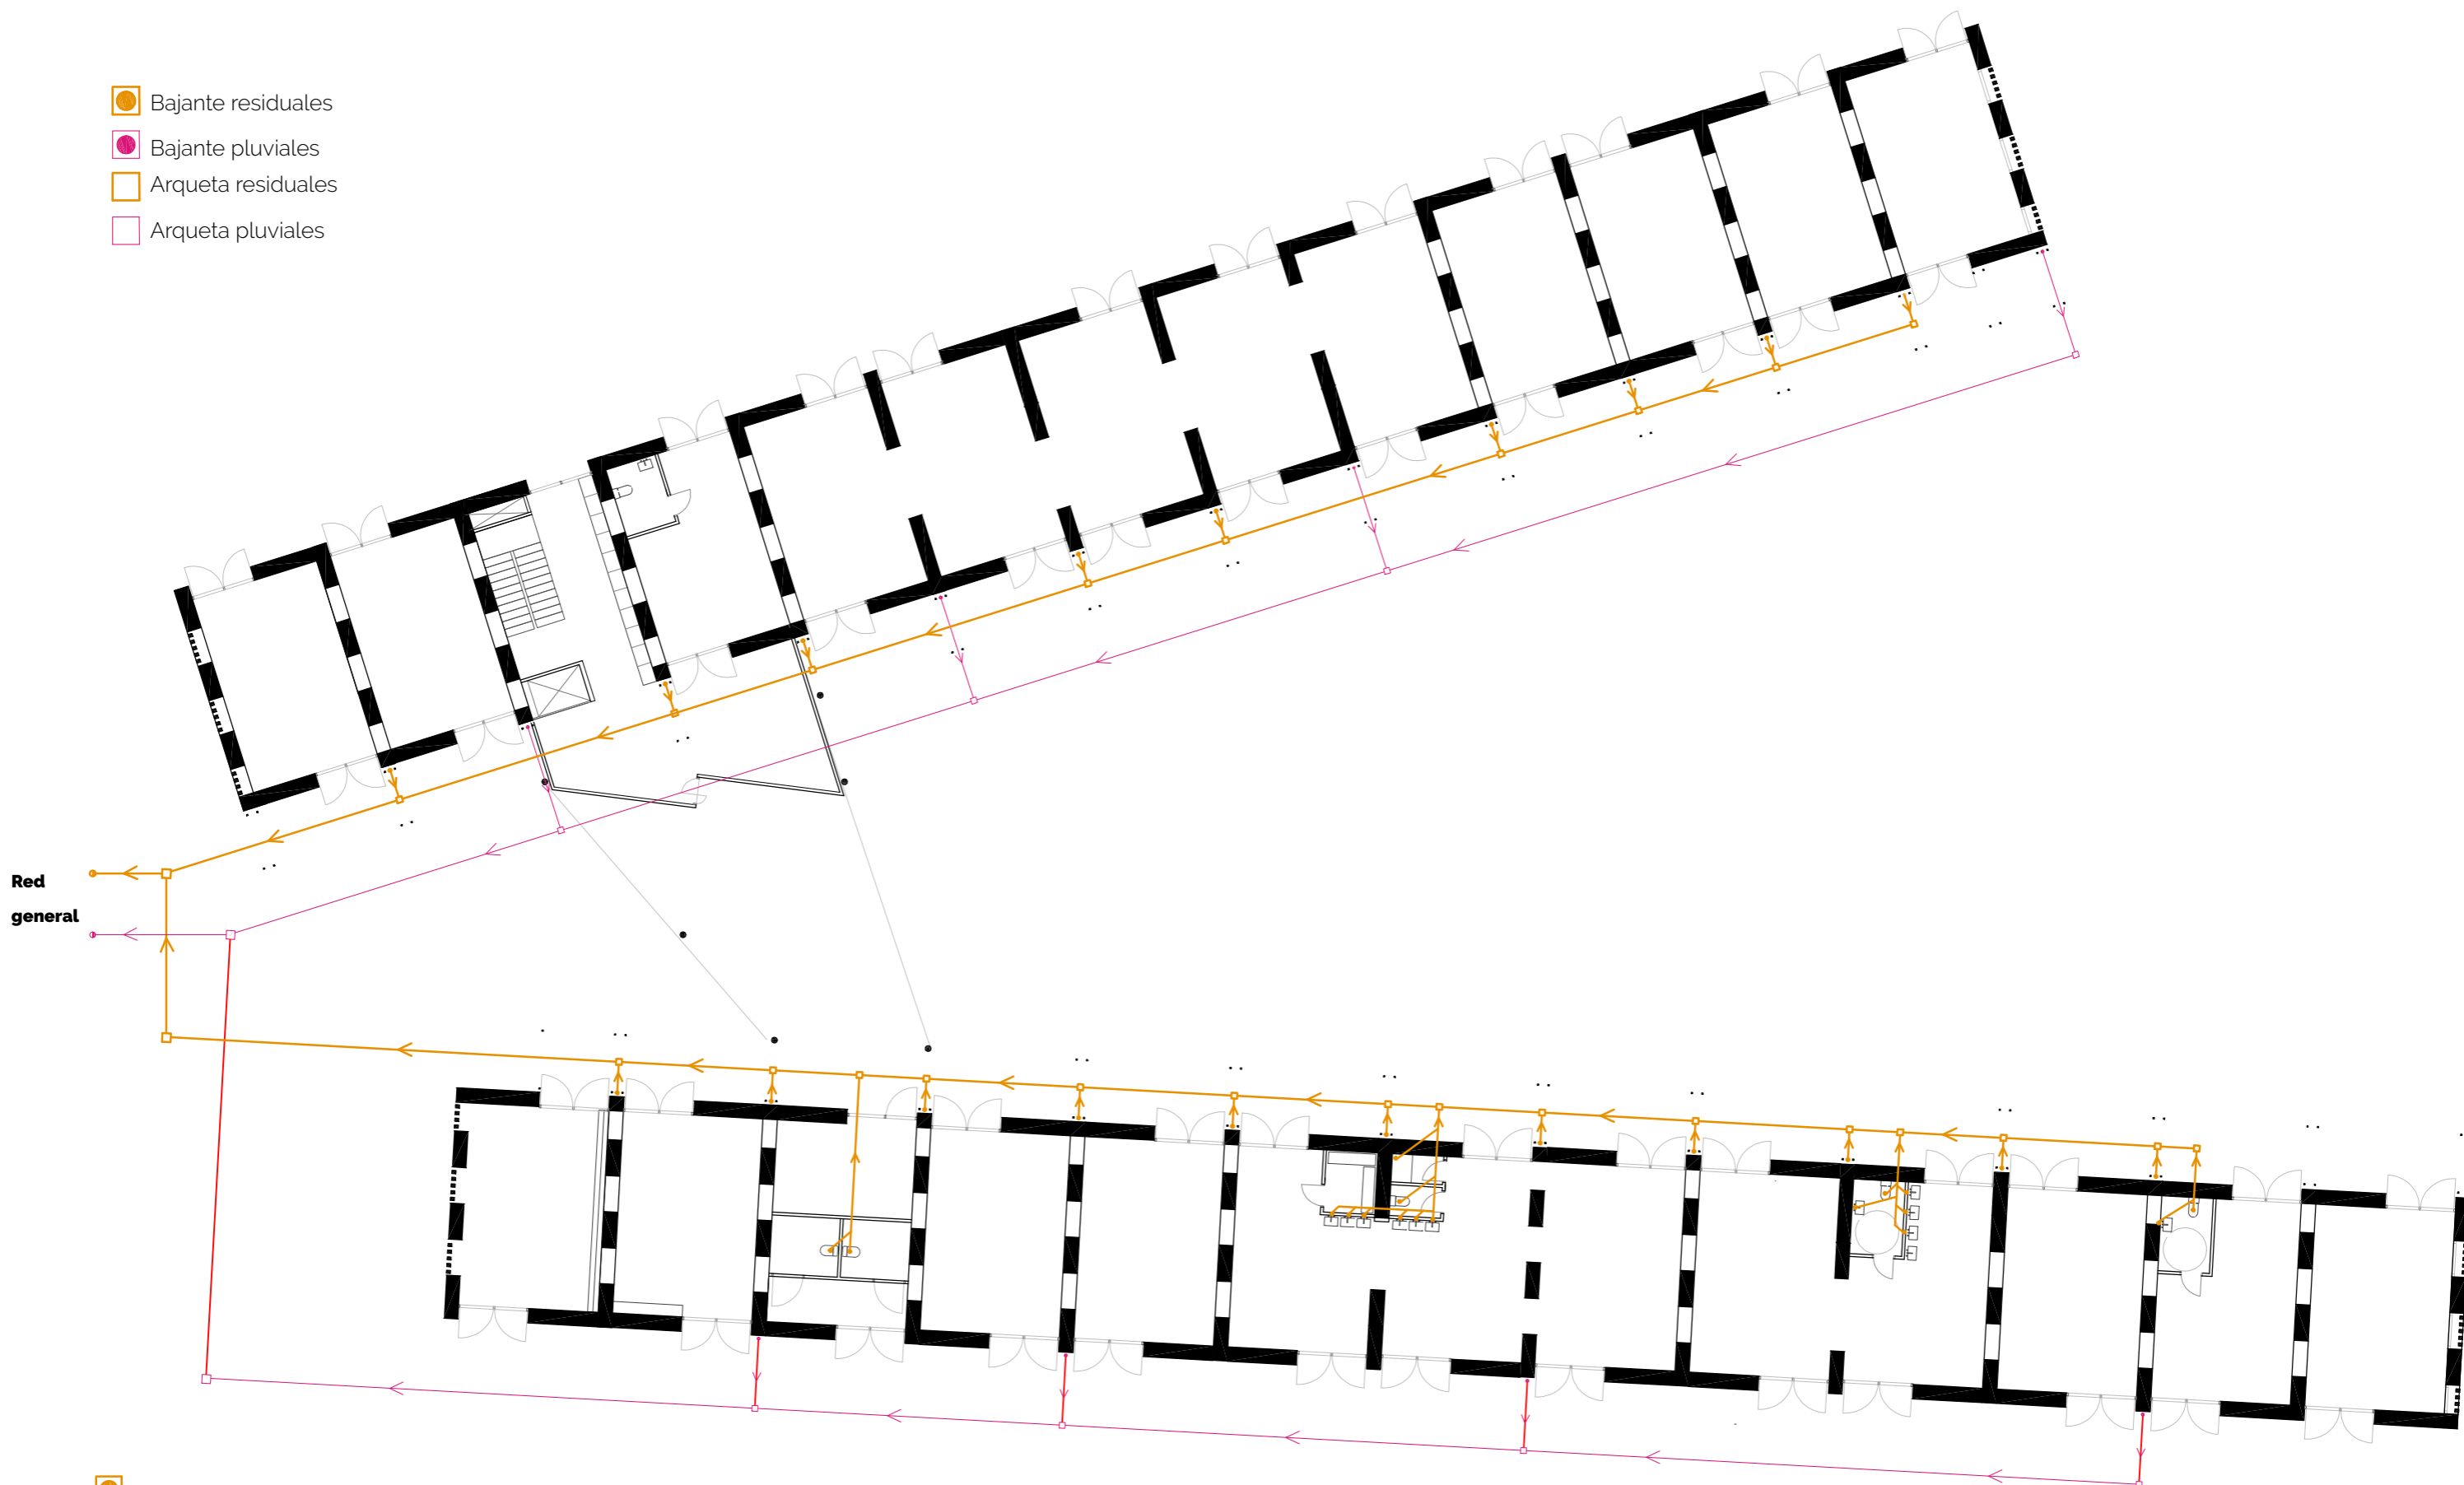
Esquema de la red de saneamiento en planta baja corte por encima de las bóvedas de ladrillo. Elaboración propia
